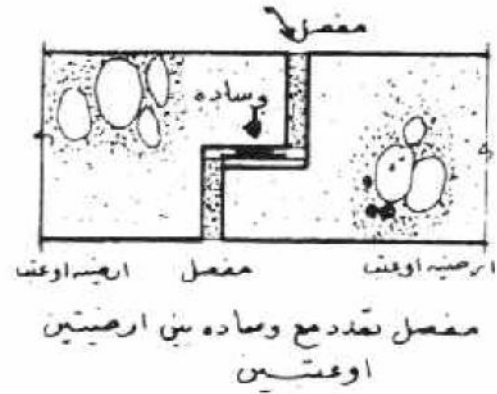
٤) مفاصل تمدد مع وسادة
